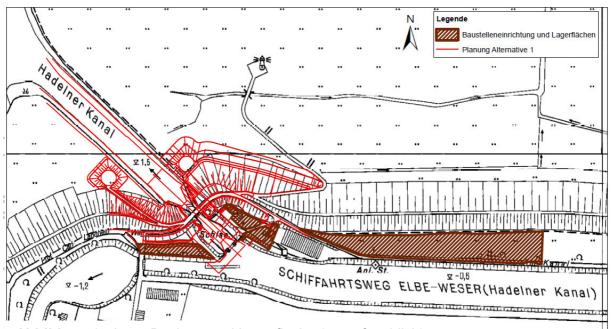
Lage Baubüro und Lagerfläche (unmaßstäblich)
